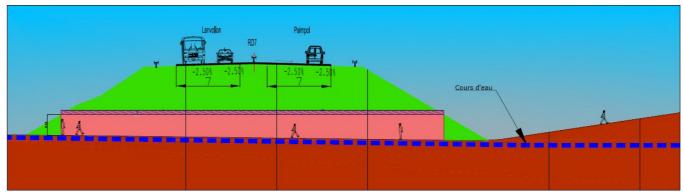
La coupe longitudinale de l'ouvrage mixte dans la vallée du Kerfot
